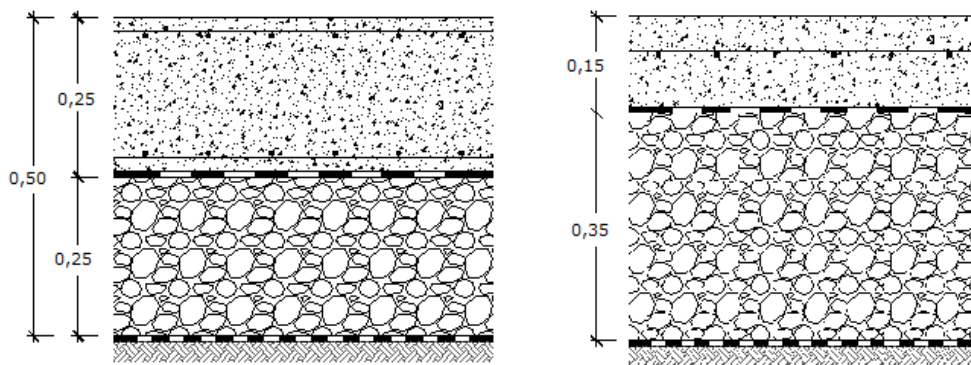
Esquerda: Pavimento LT1; Direita: Pavimento LT2.
